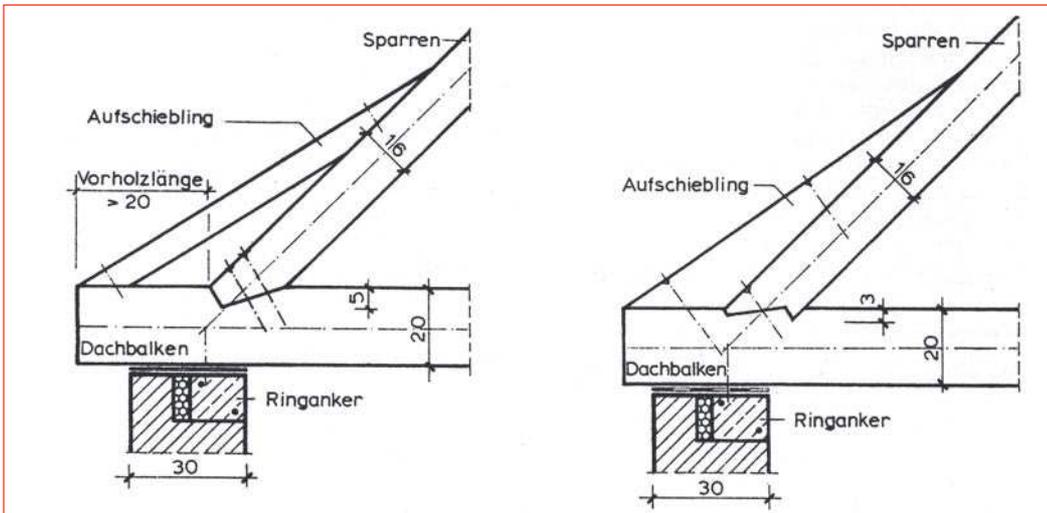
Fußpunktausbildung eines Sparrendaches (Holzkonstruktion):
